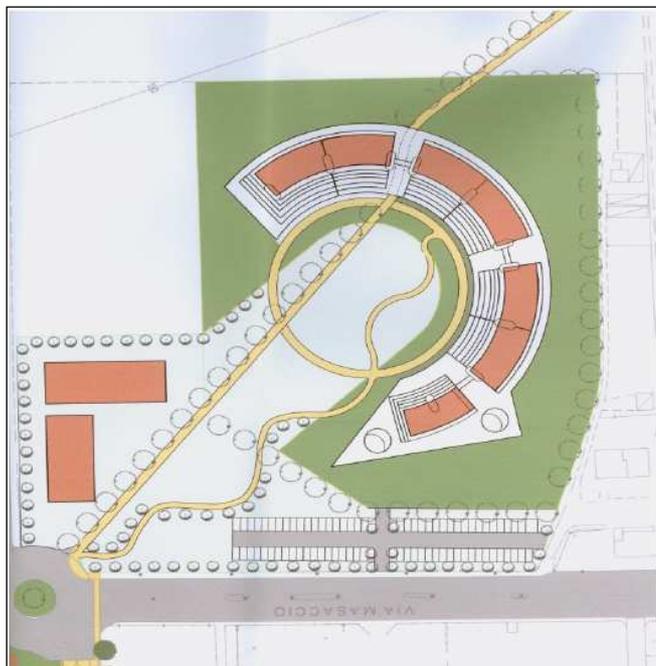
planivolumetrico PII “Centro Sportivo” adottato e decaduto
